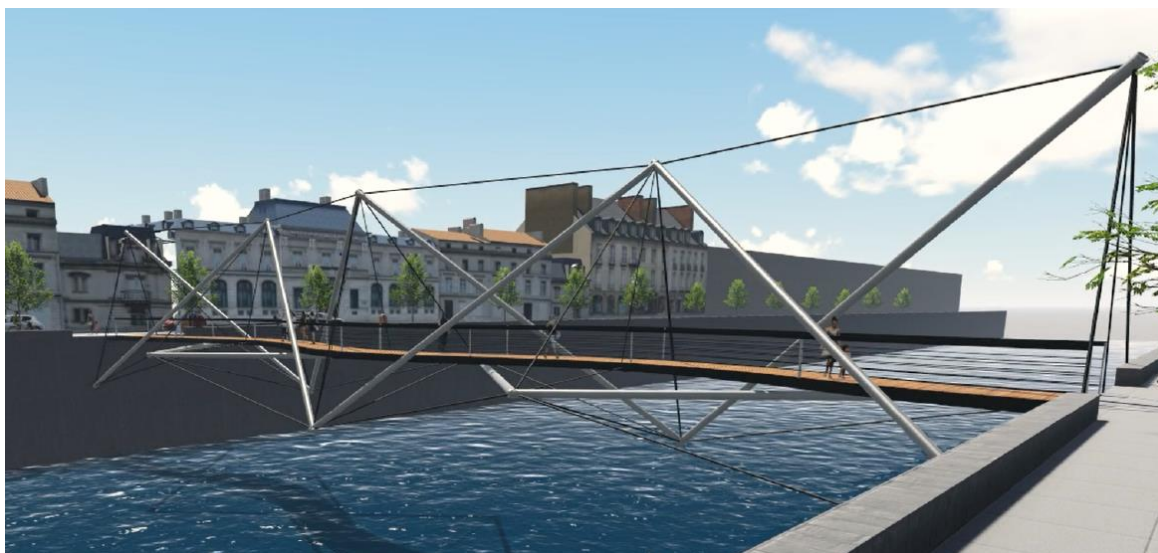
Passerelle piétonne en tenségrité « Snake Footbridge » [22]
